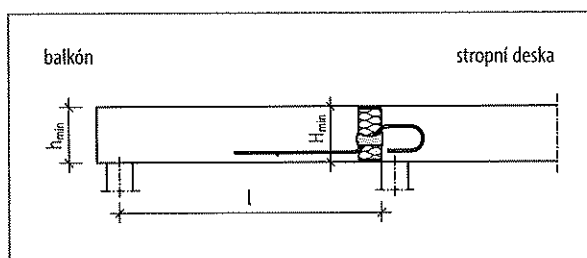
Schöck Isokorb® T typ QL-VV4 až QL-VV6: Statický systém
